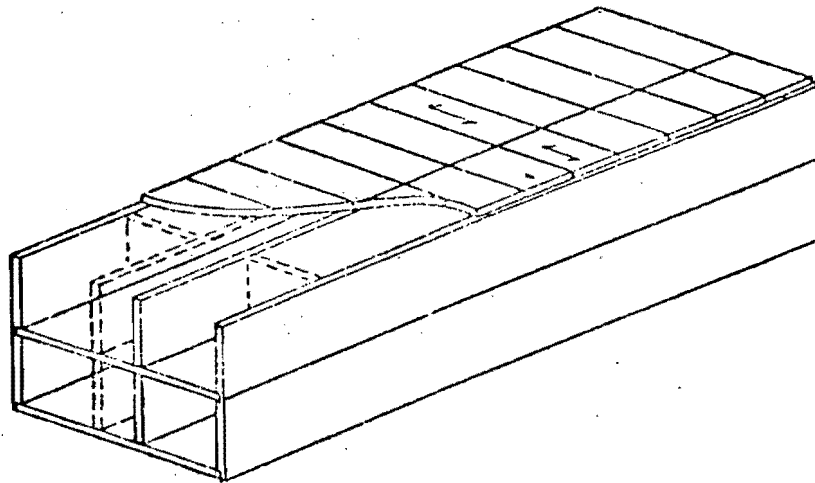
Sistema con muros de carga longitudinales (ref 3)
